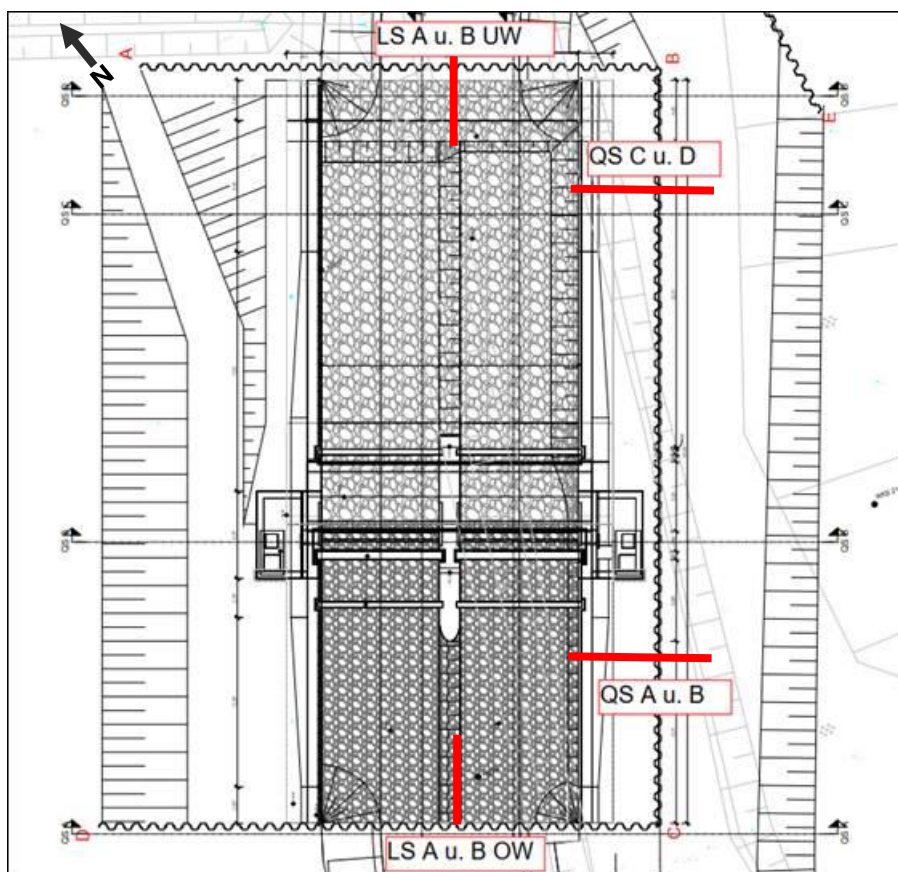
Grundriss Baugrube Durchlassbauwerk HRB Bauernhöfen, Quelle: Nach THP
